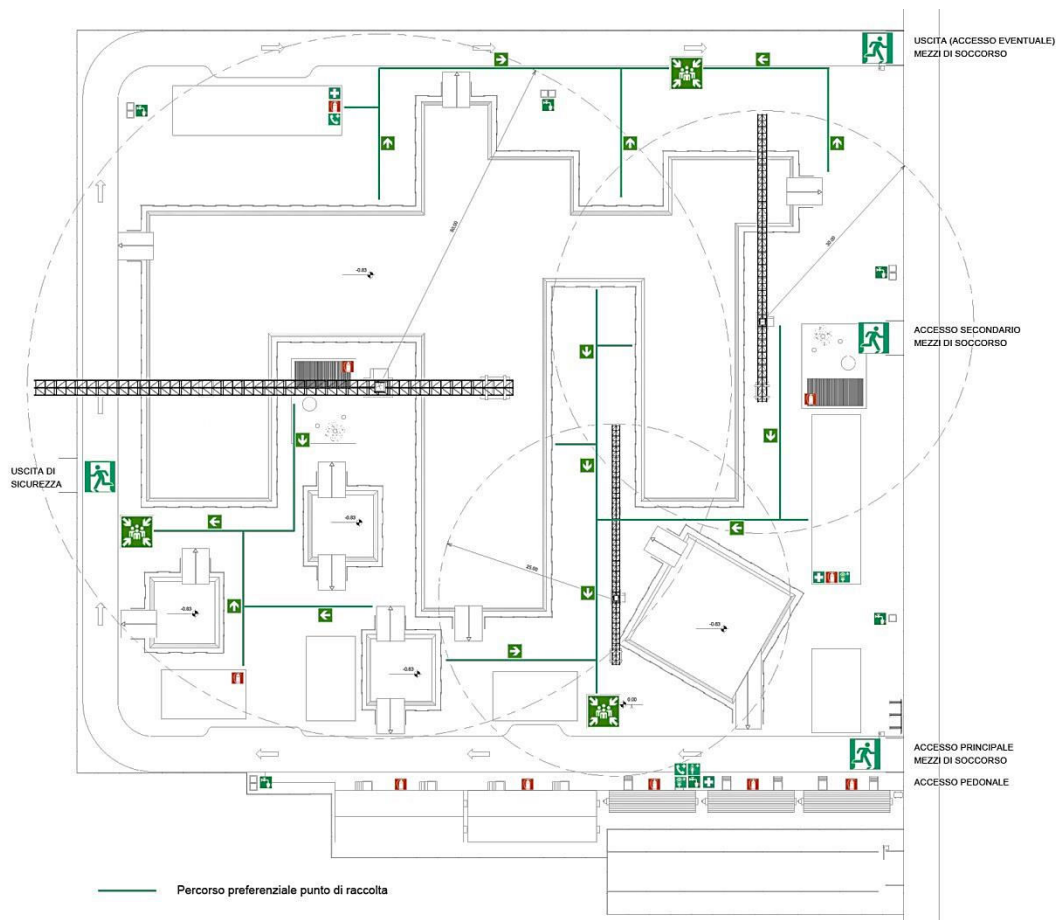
Layout di cantiere: gestione delle emergenze.
